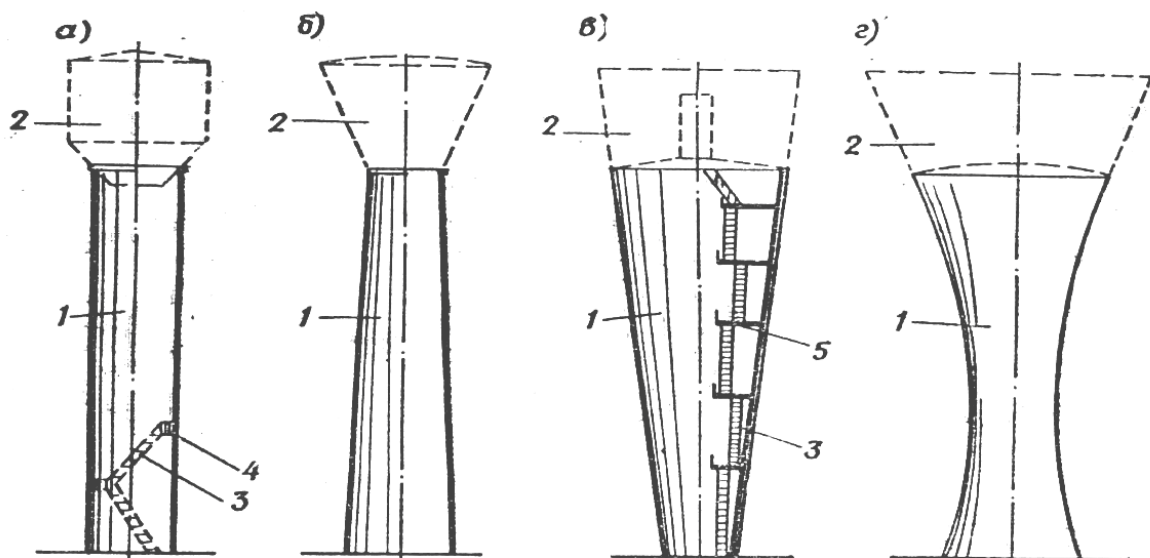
Разновидности водонапорных башен в виде оболочек: 1- опора; 2-резервуар; 3- лестницы; 4- металлические площадки; 5- железобетонные площадки.
